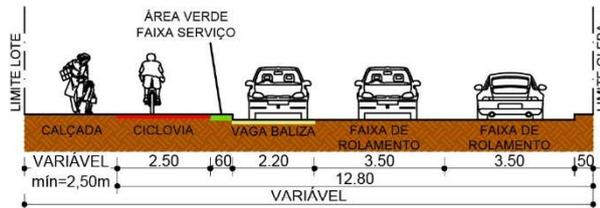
Via Veneto (trecho entre lote 11 e vizinho) – Perfil da Via
